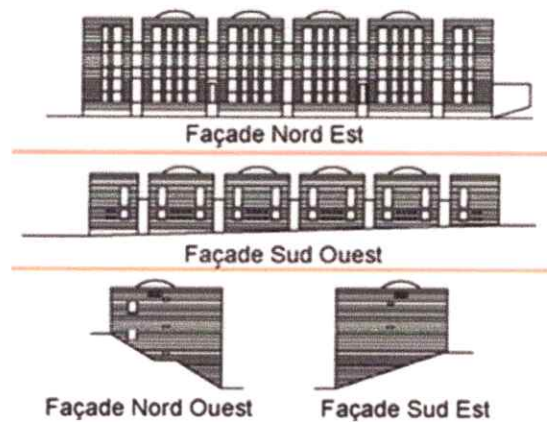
façades du bâtiment linéaire de la partie haute
